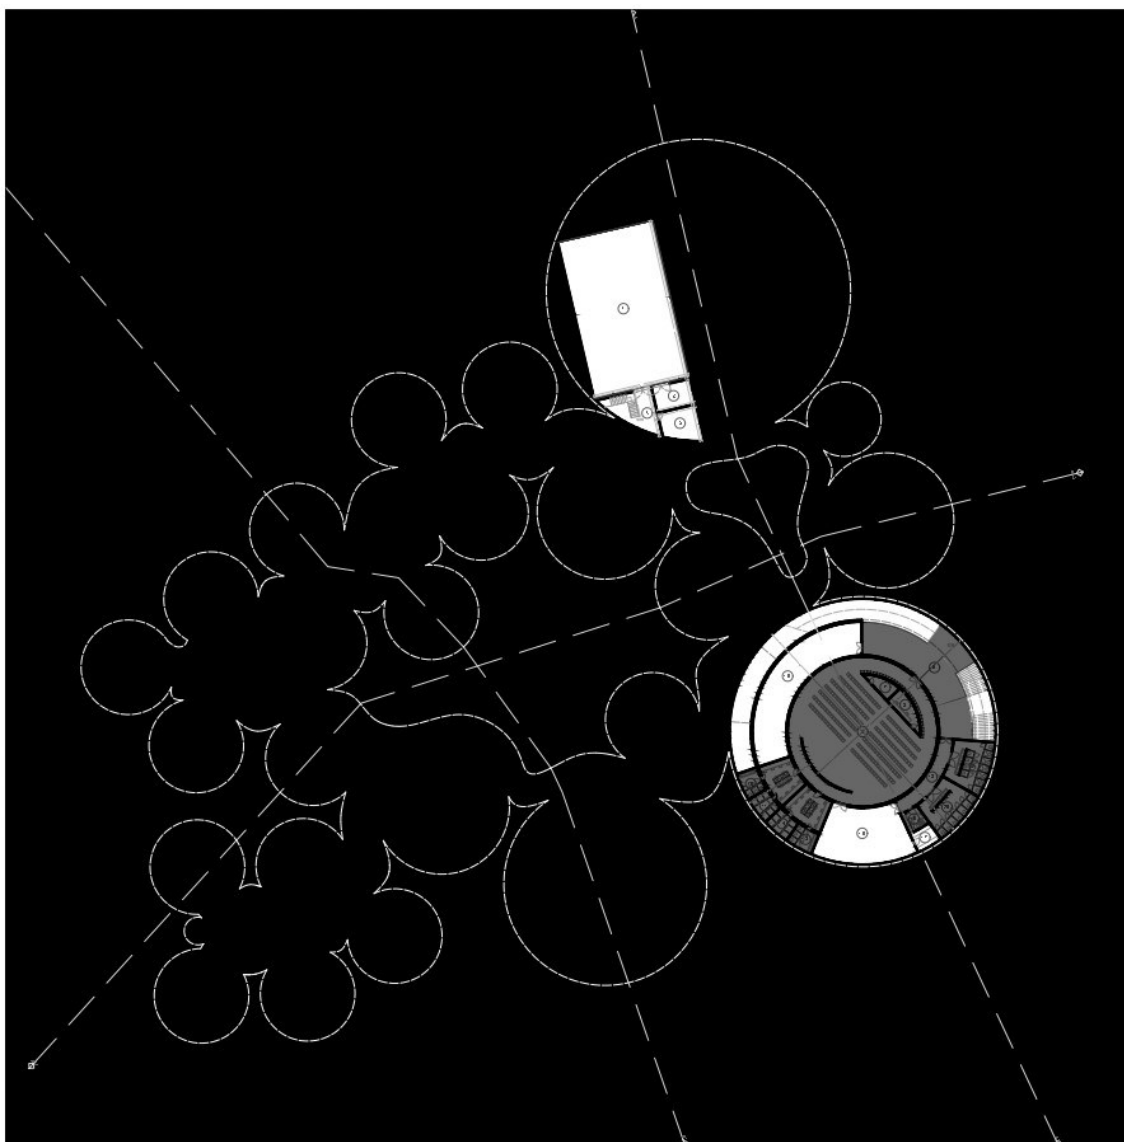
Planta do Nível Subterrâneo do Pavilhão Desportivo
